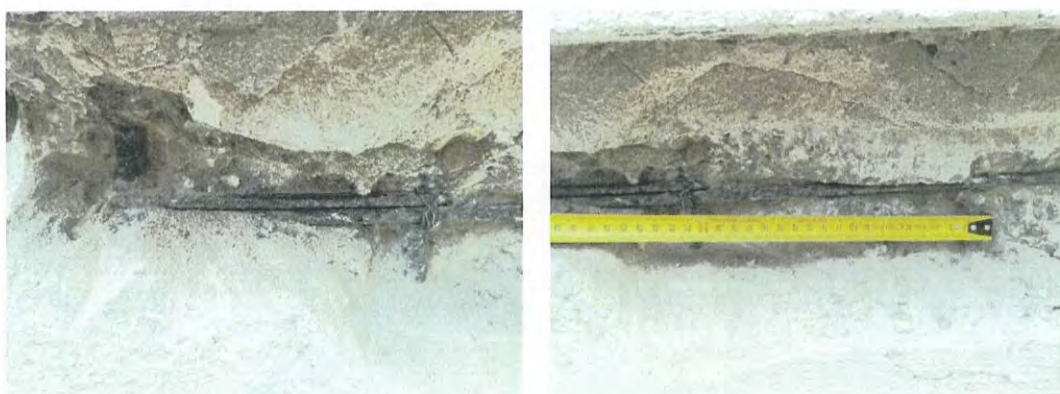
a, b– Aspect sondaje armare consolidări elevații
